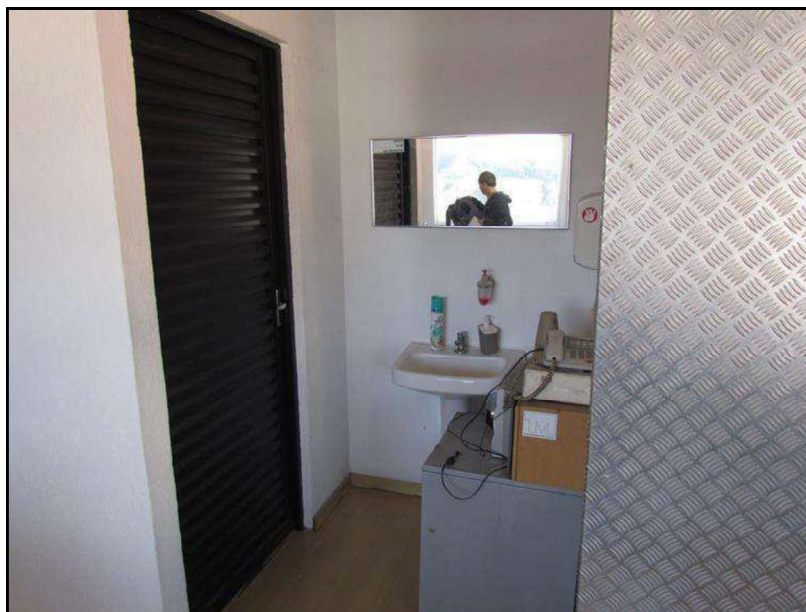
Vista do hall que antecede o lavabo no 2º pavimento.
